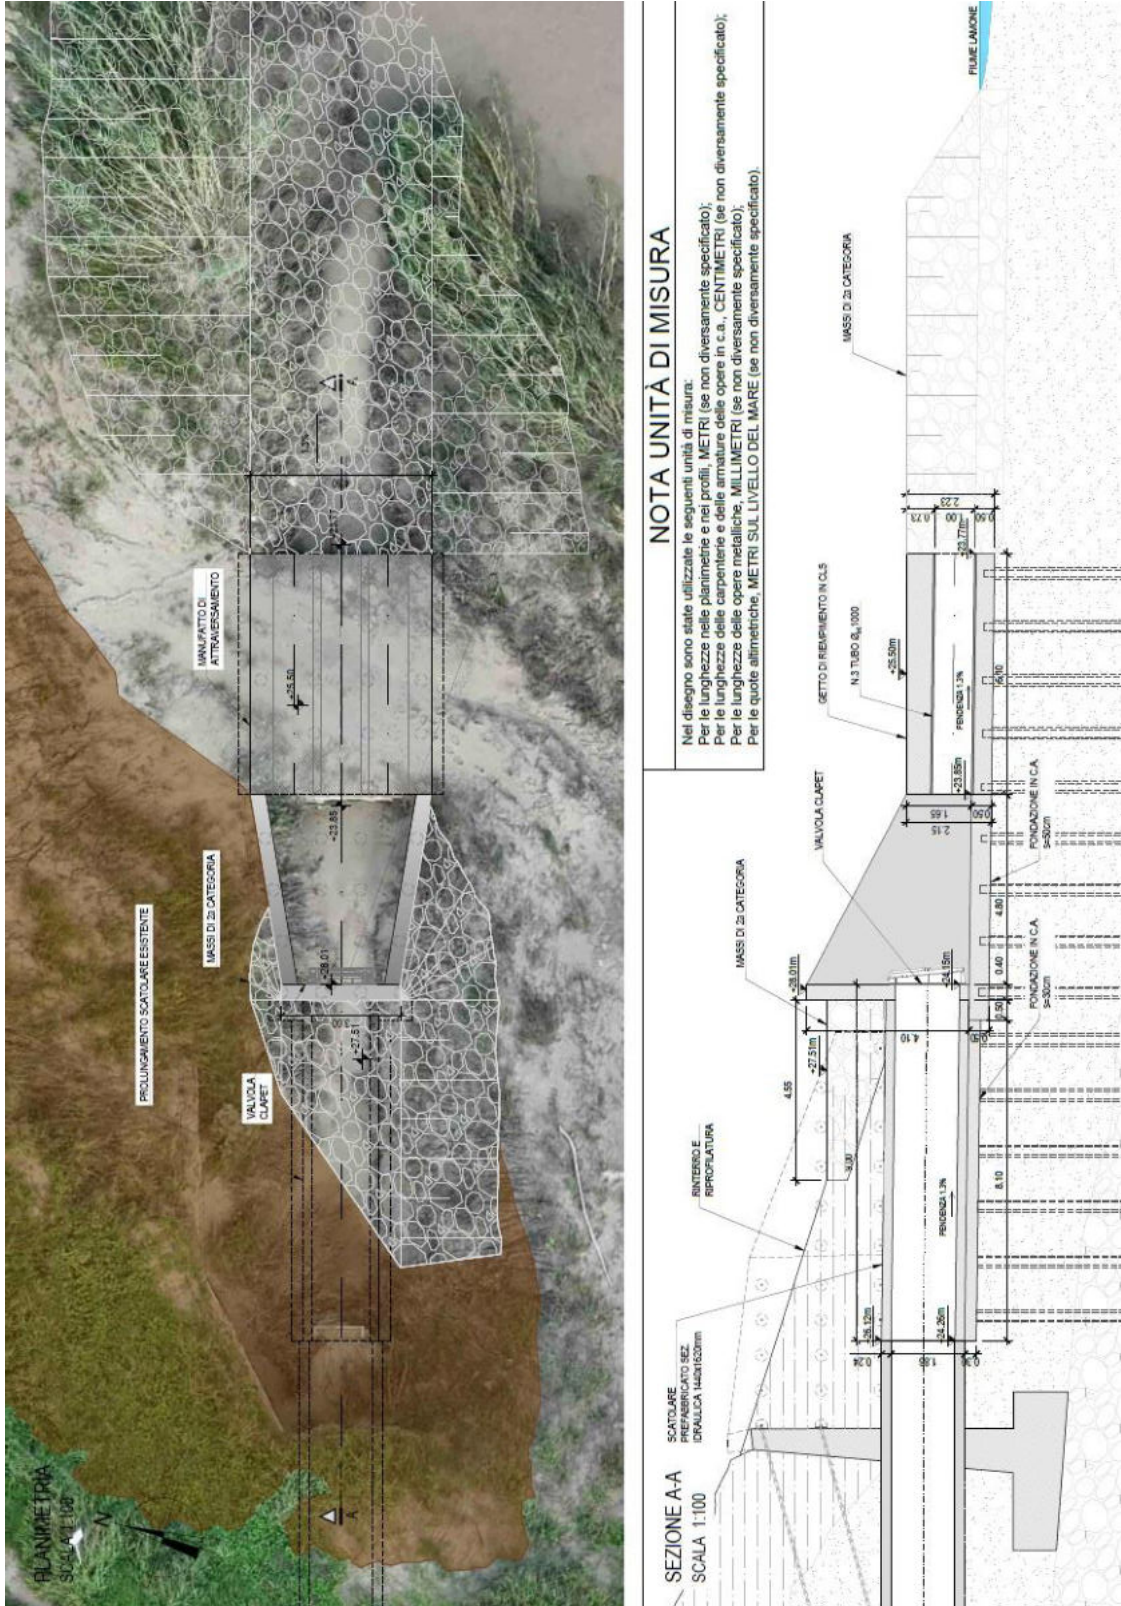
Pianta e sezione delle opere di protezione dello scarico n.37
